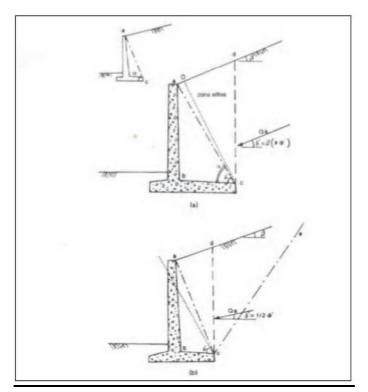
Spinta sui muri di sostegno a mensola con suola lunga (caso a) e con suola corta (caso b).
